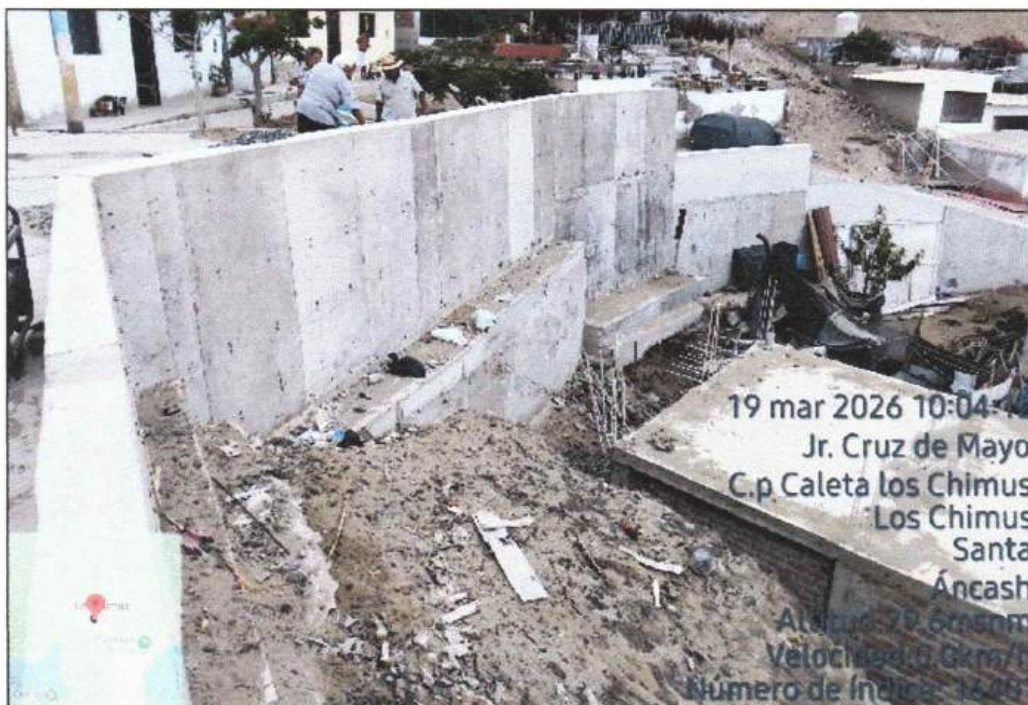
y N°14: Fisura generada en contorno de caja exterior
